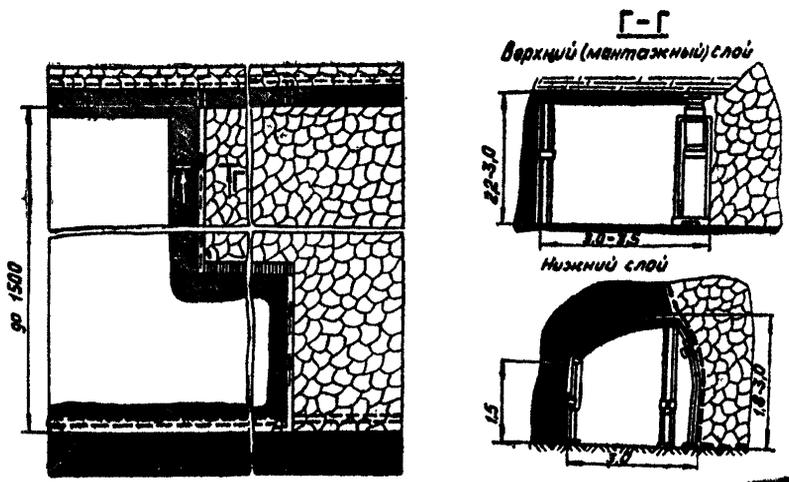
Схема подготовки и отработки выемочных полей с проходкой вентиляционной (конвейерной) выработки позади очистного забоя при разработке мощных пластов наклонными слоями с применением гибких перекрытий и крепи КТУ
